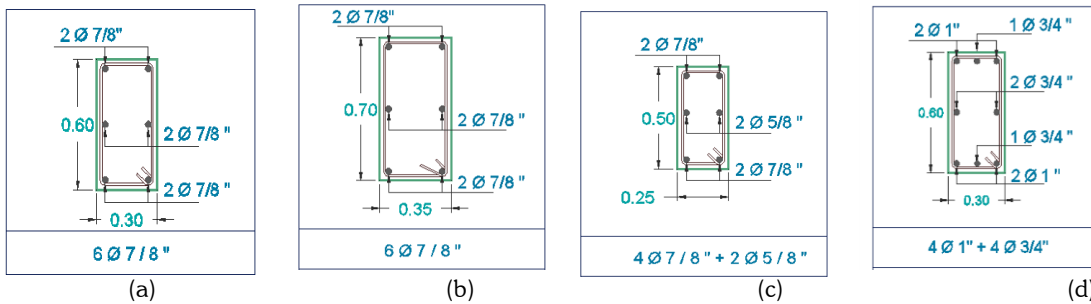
(a) Esquema de columnas, Pabellón 1A. (b) Esquema de columnas, Pabellón 1B. (c) Esquema de columnas, Pabellón 1C. (d) Esquema de columnas, Pabellón 4J.
